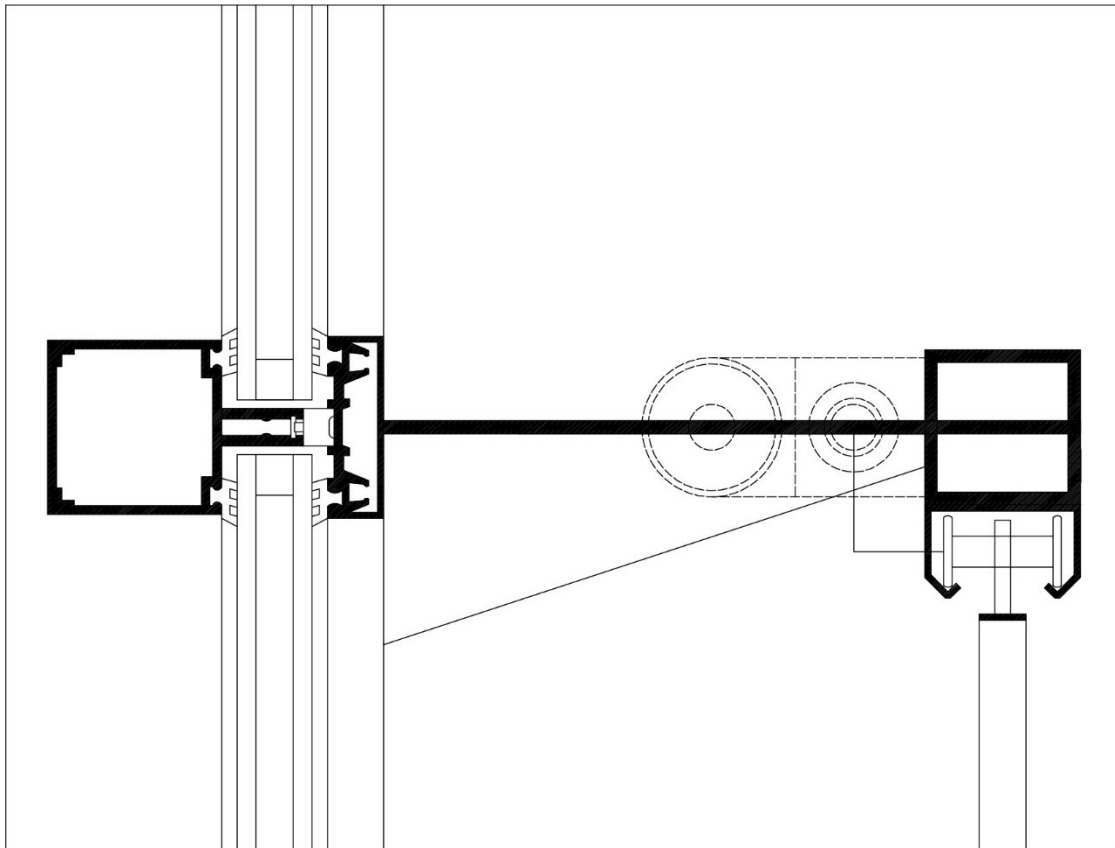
Seconda soluzione di sistema di collegamento attraverso l'ancoraggio di mensole e studio dell'attuatore. Le linee tratteggiate indicano l'ipotetica collocazione dell'attuatore. Fonte: elaborazione propria, 2024
